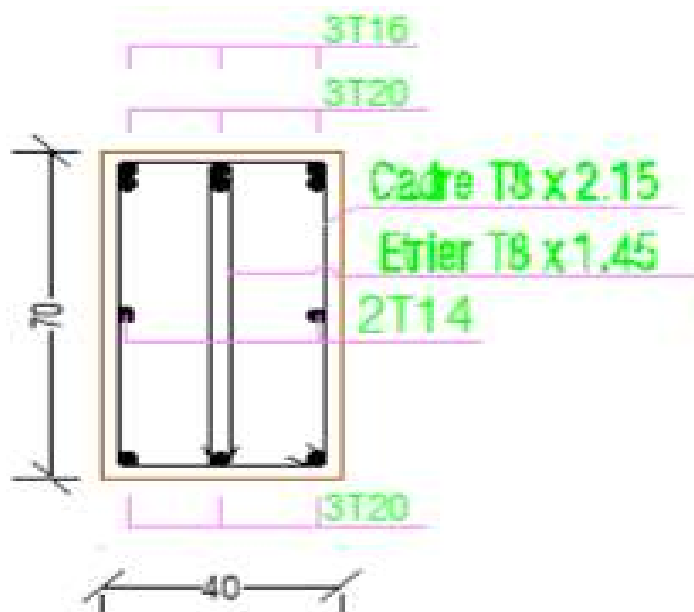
Disposition constructive des armatures des poutres sur travée.
